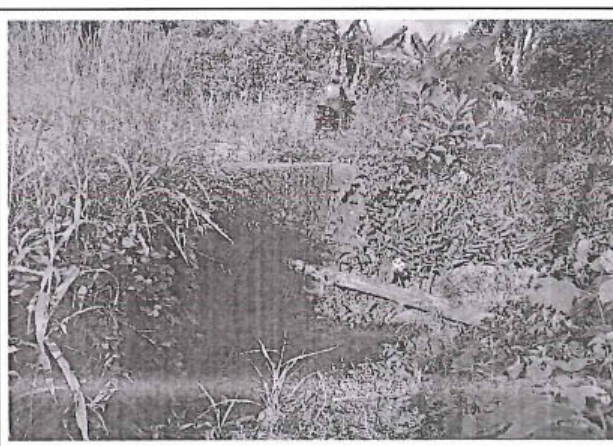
Alcantarilla TMC en buenas condiciones, el area de
